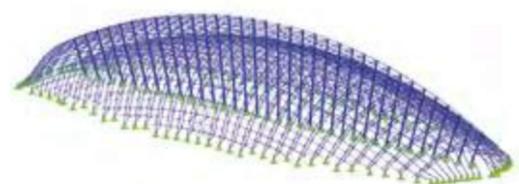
Вариант конструктивного решения ЭКД-Земля с поднятой частью покрытия
